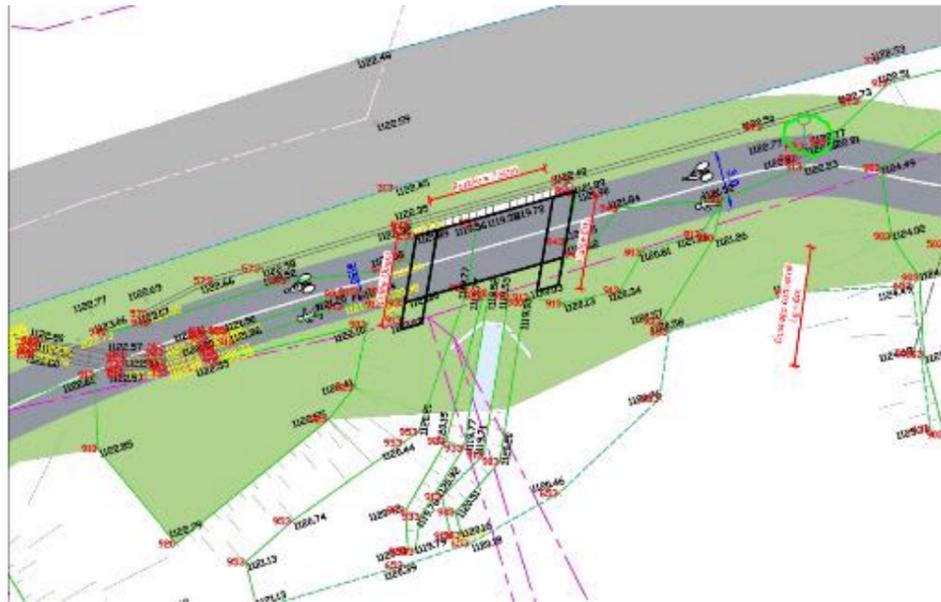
Section 2-5 - Implantation du passage sous route du bief de la Chaille
